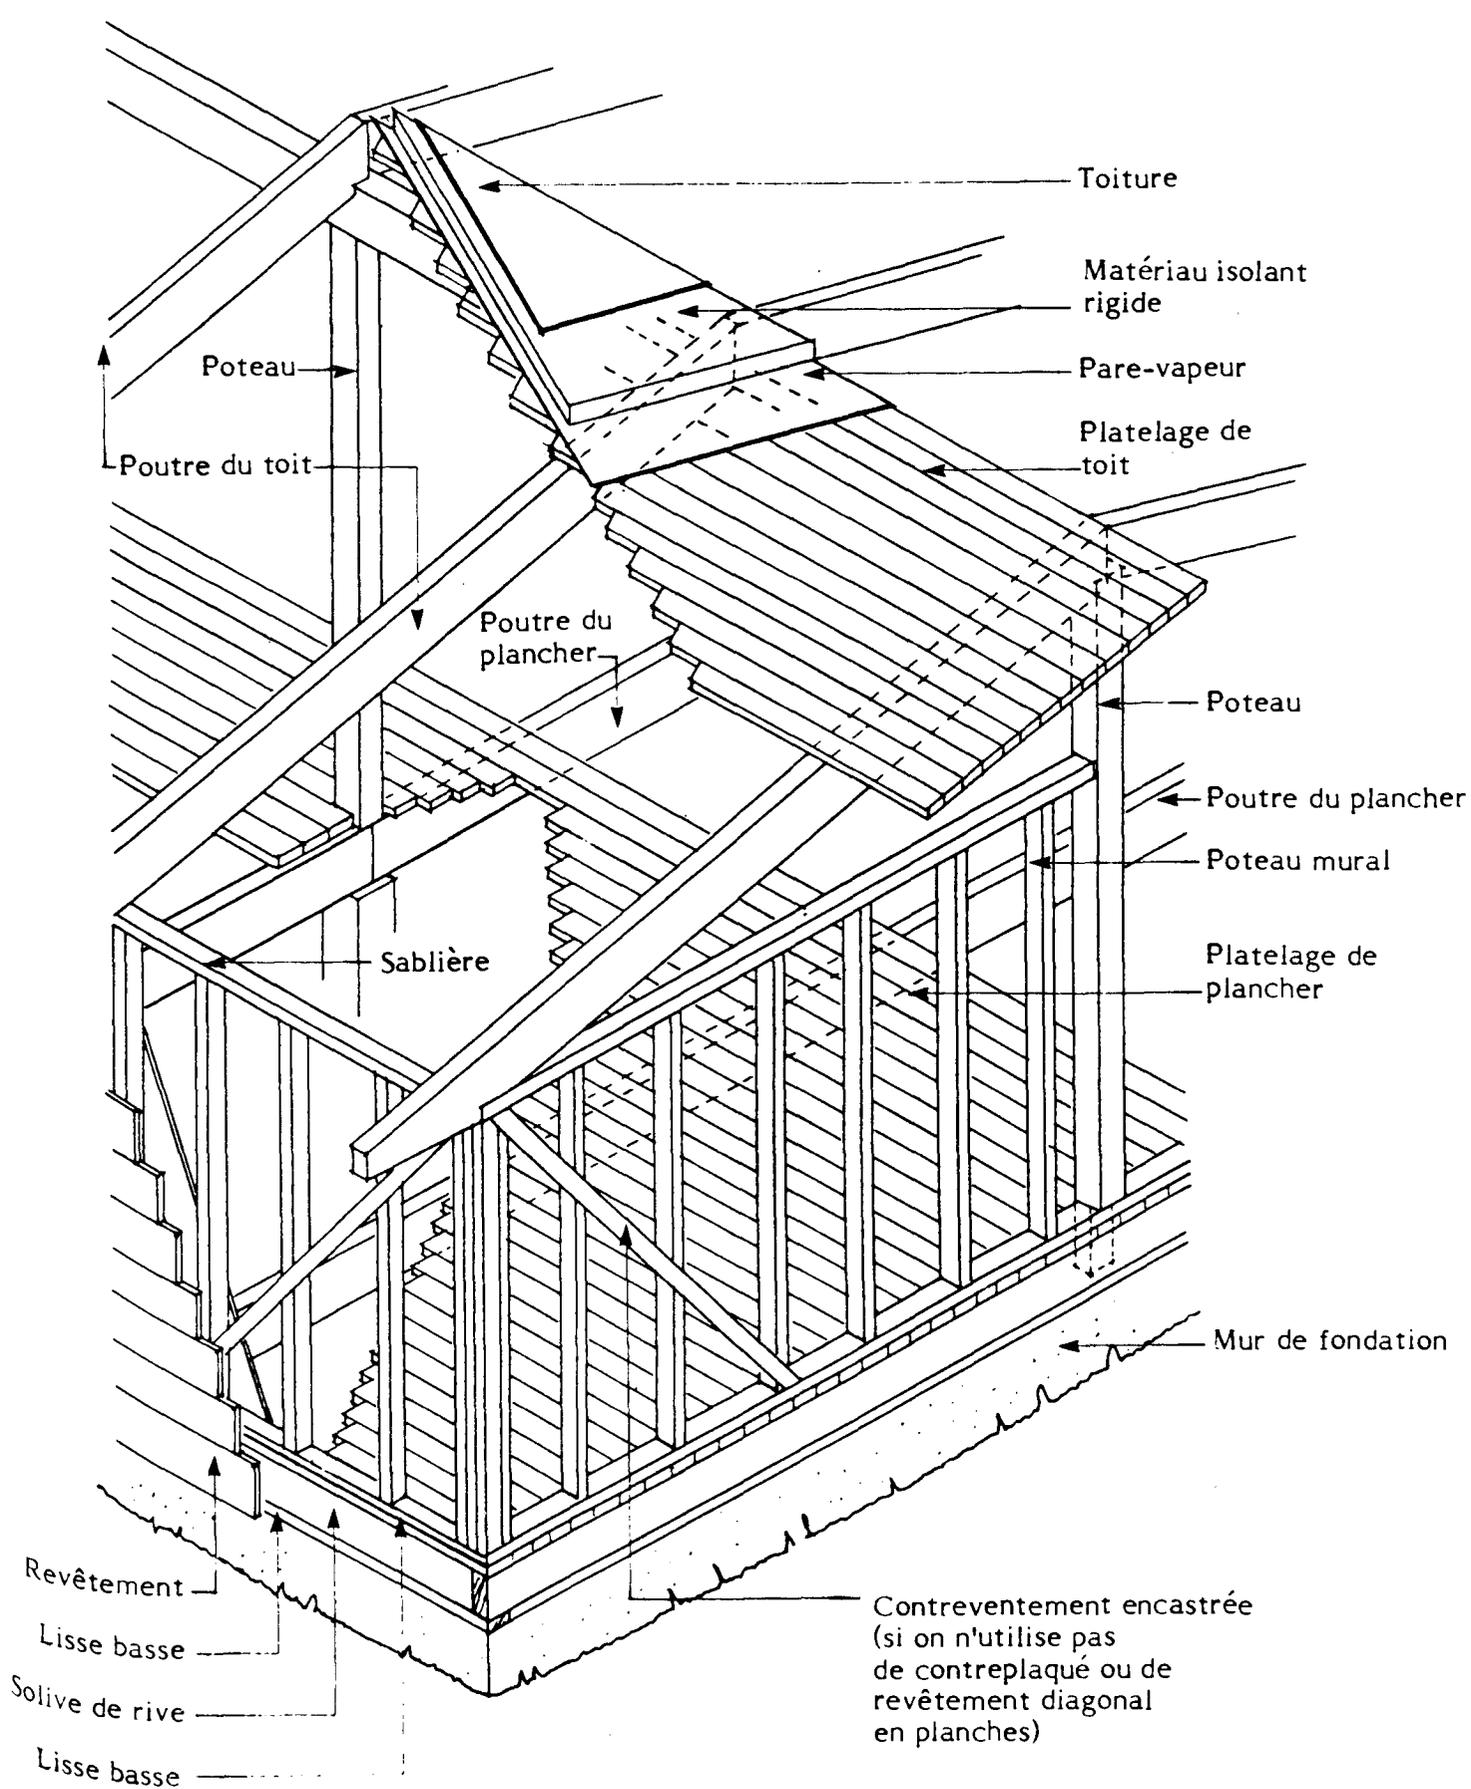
CHARPENTE À POTEAUX ET À POUTRES, MODÈLE MODERNE
